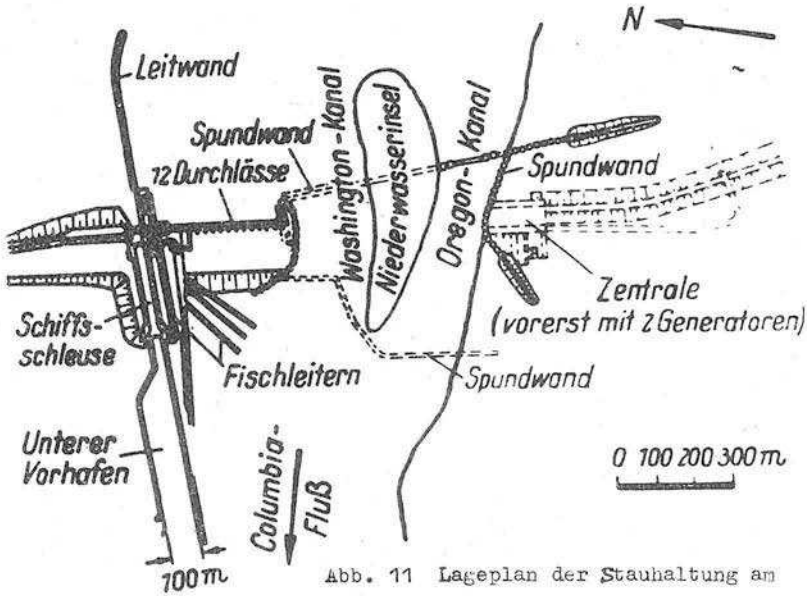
Lageplan der Stauhaltung am Columbia-River mit der Schleuse Mc Nary
